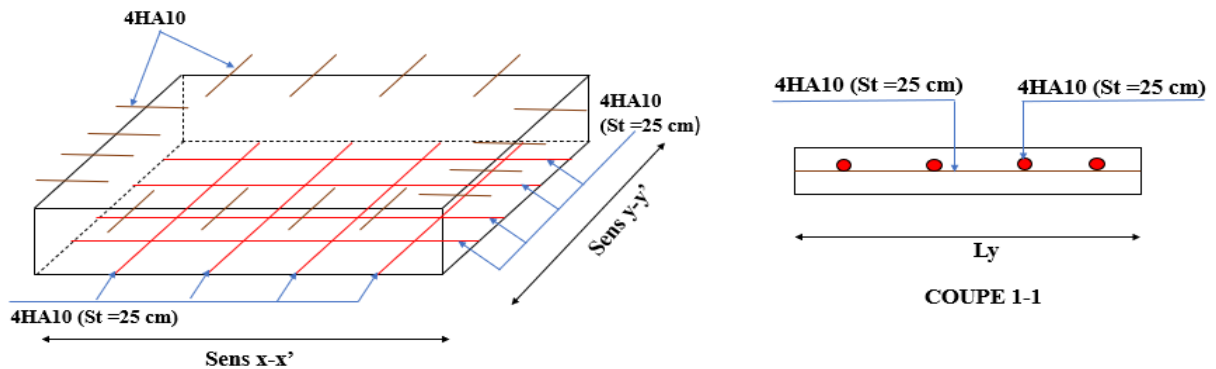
Schéma ferrailage de la dalle ascenseur de la locale machinerie.
